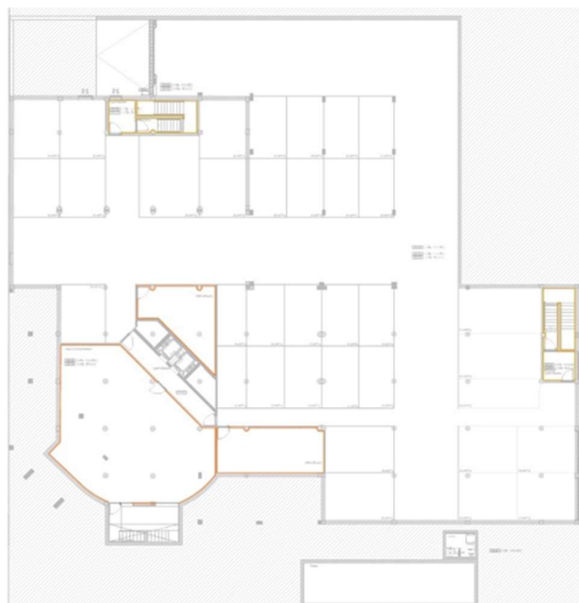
Pormenores construtivos dos rodapés do piso -1
